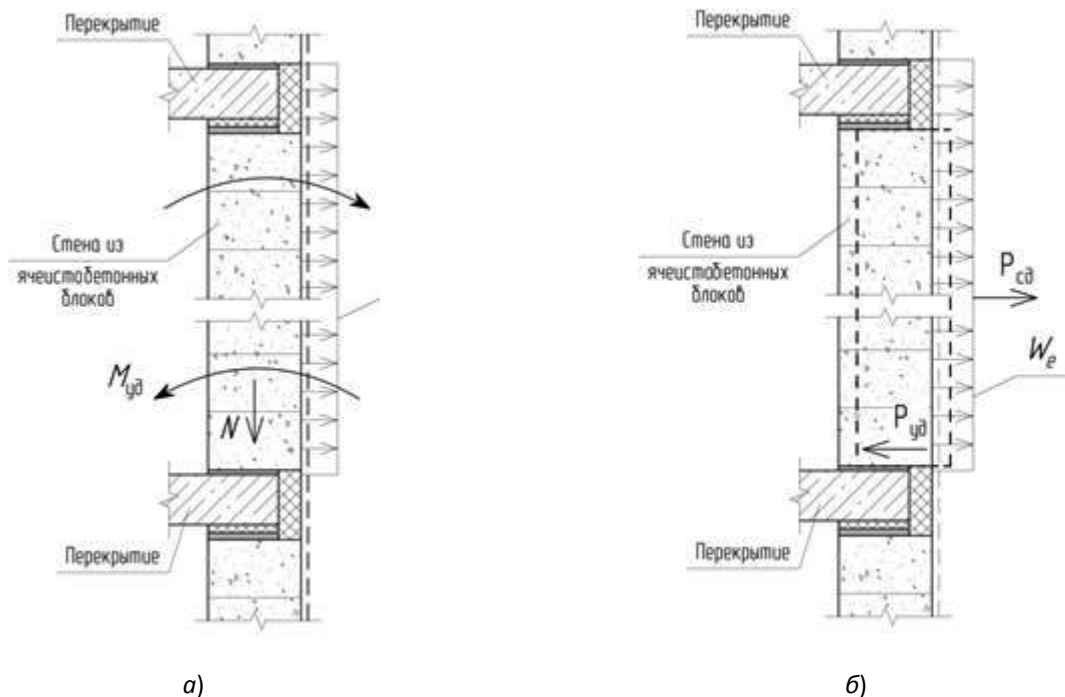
Расчетные схемы поэтажно опертой стены
